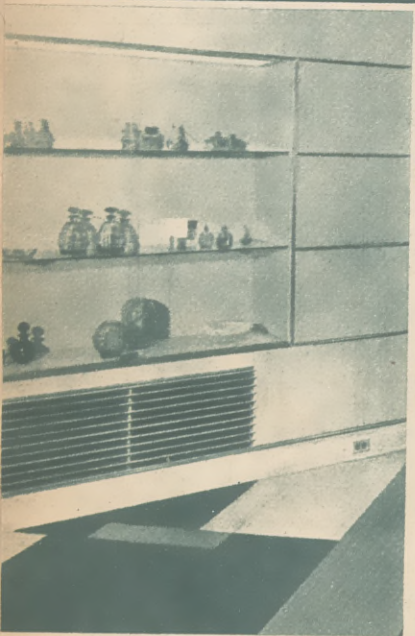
La vitrina empotrada en el muro es muy práctica para las casas de nueva planta
